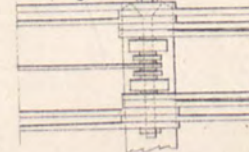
SEMELLE SUPÉRIEURE. — Plan supérieur.
